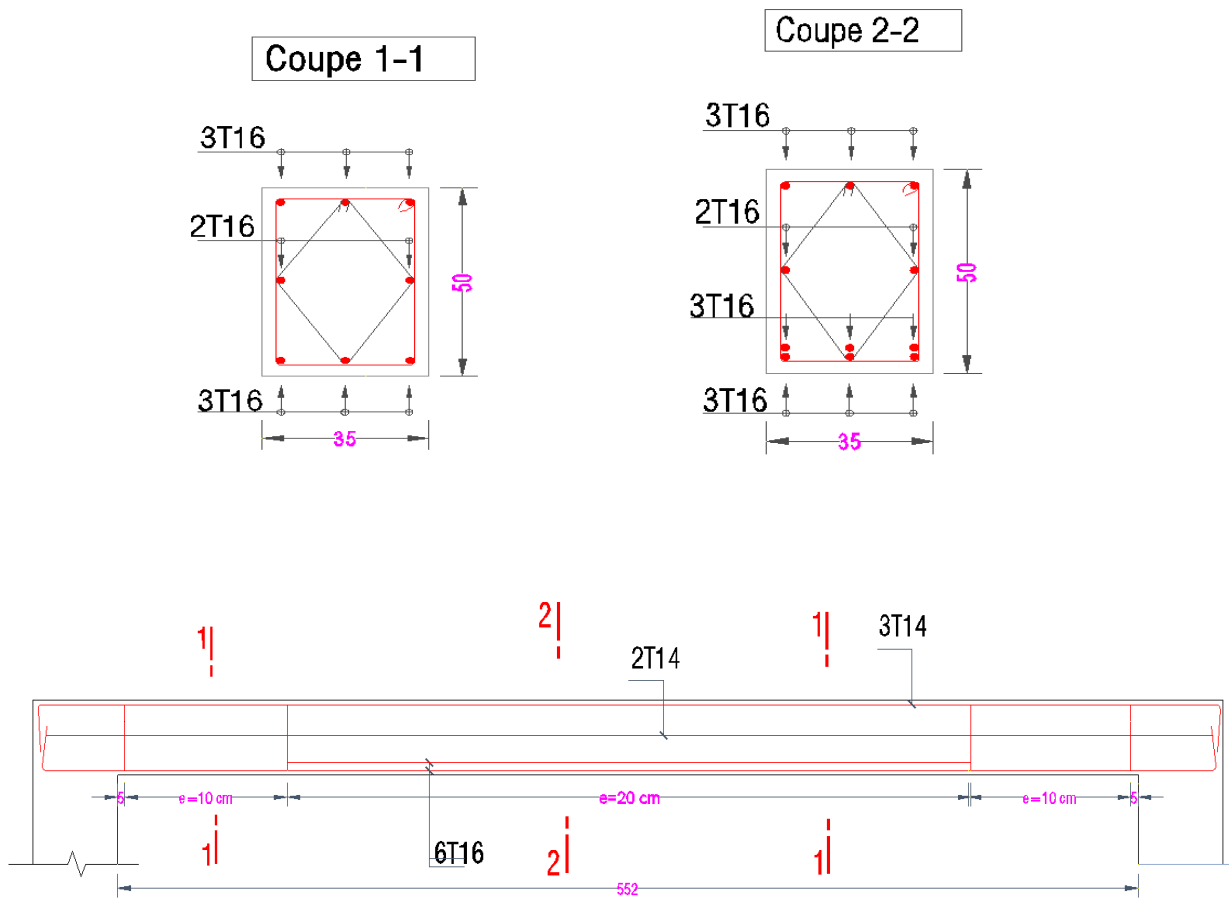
Schéma de ferrailage de la poutre palière des escaliers de deux volées
